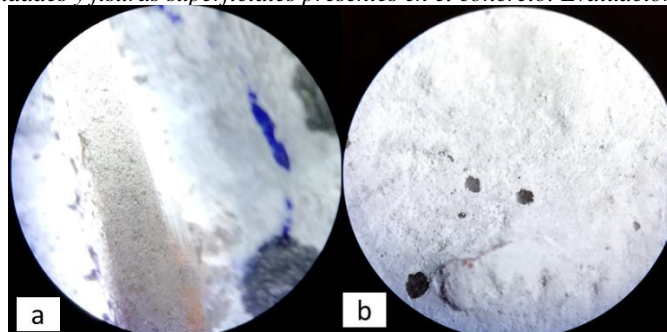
Probeta Piedra 4 2b con 0.21 ml de Aditivo Bacteriano. (a) vista interna de la fisura inducida (b) vista de discontinuidades y fisuras superficiales presentes en el concreto. Evaluación a los 28 días.
